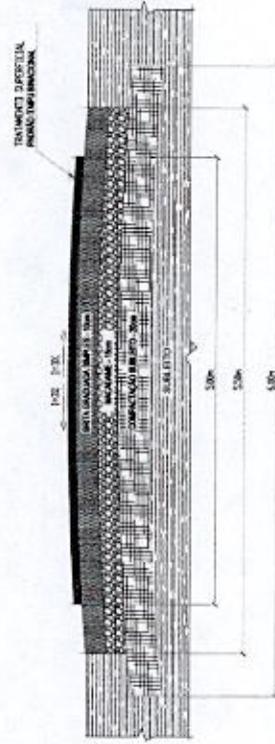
Exemplificação da declividade, base e sub-base e espessura e largura das camadas do pavimento.
